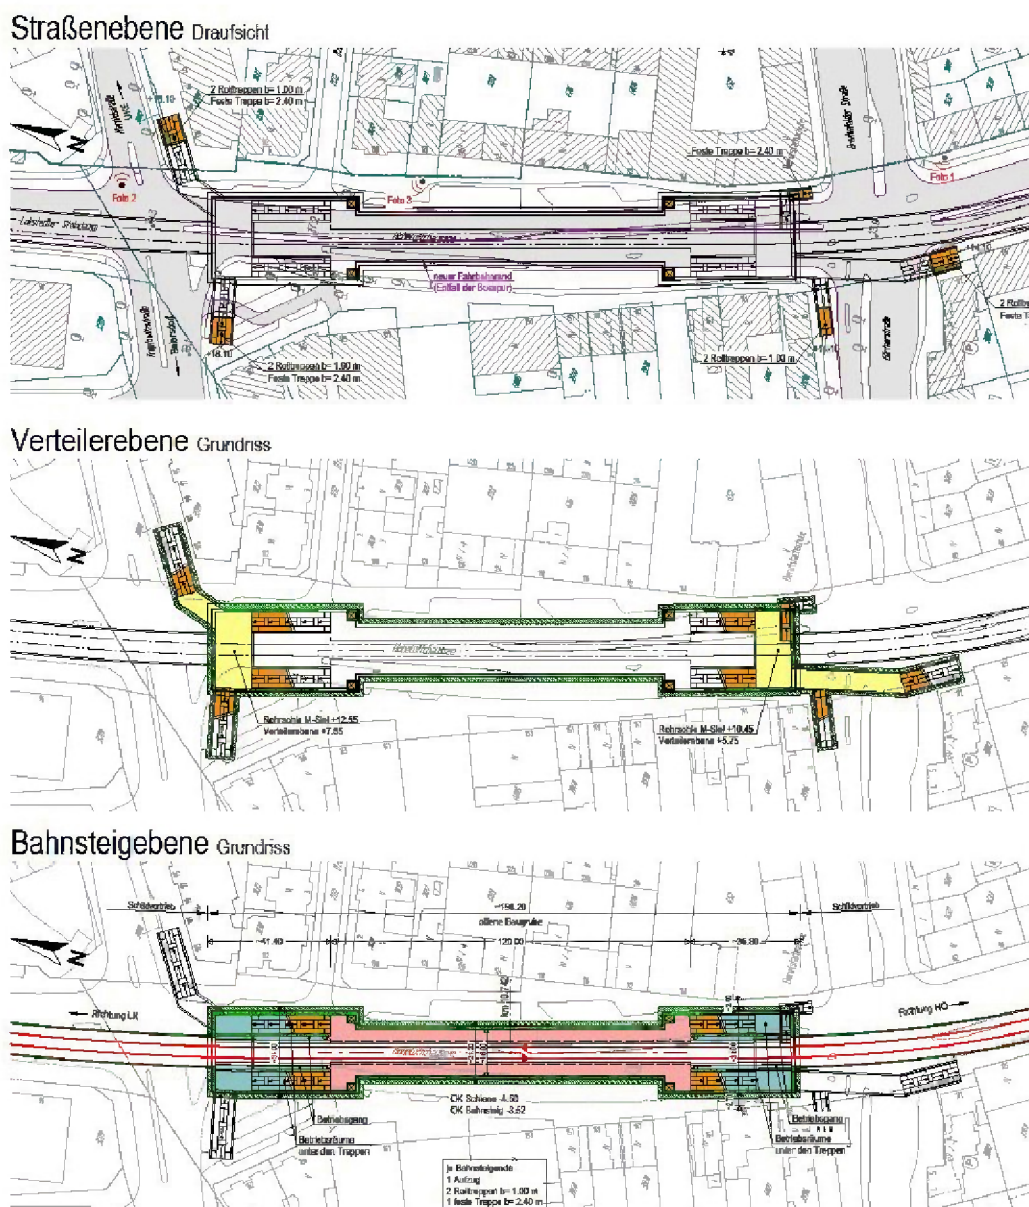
Lageplan Haltestelle Gärtnerstraße I
